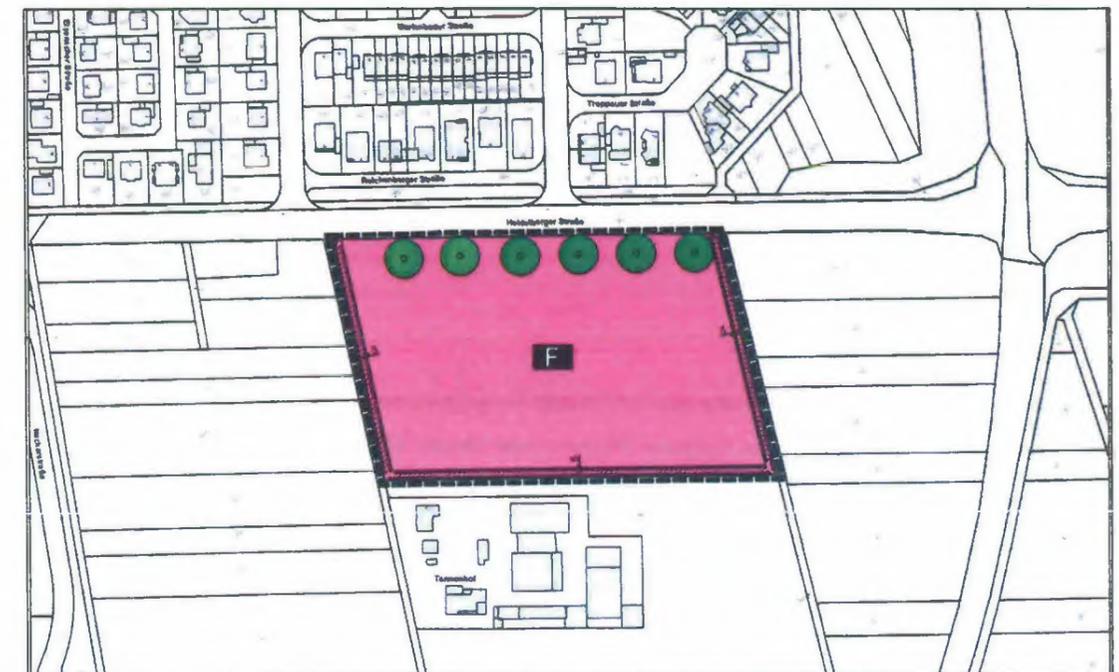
Bebauungsplan „Feuerwache Heidelberger Straße“ (Stand: 03.04.2023). Quelle: PlanEs.
